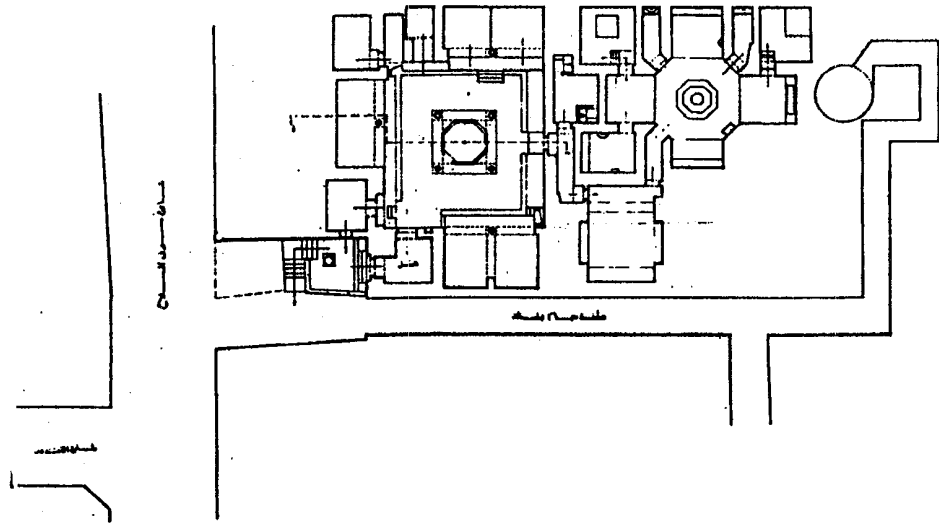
مسقط أفقي لمدرسة وجامع مصطفى قورجي بطرابلس الغرب بليبيا
